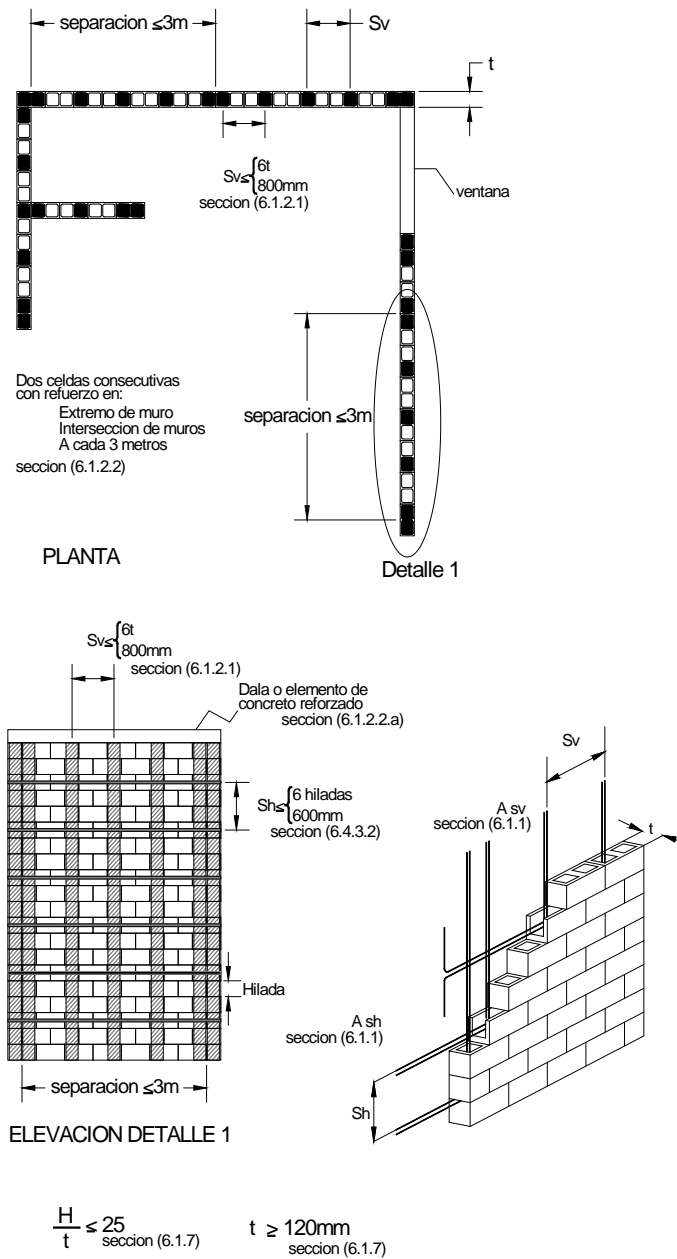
1. Requisitos para mampostería con refuerzo interior
